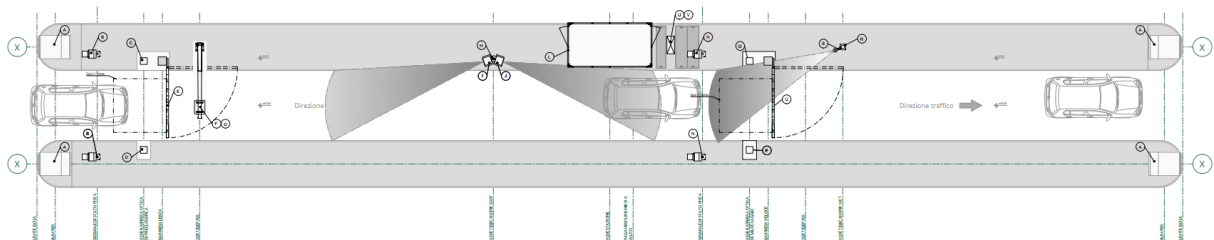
Vista in pianta della pista di esazione con ubicazione delle sbarre (sx: sbarra chiudi- pista, dx: sbarra cadenza-veicoli).
